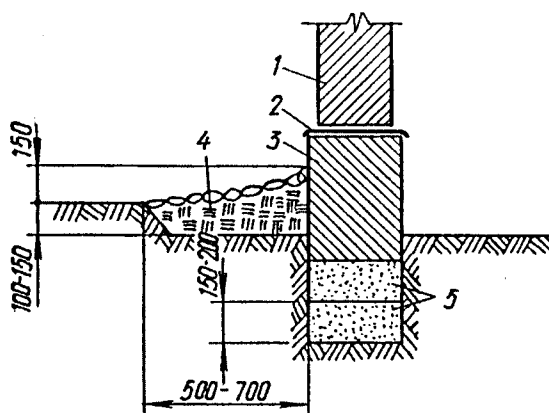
Схема кам'яного (цегляного) фундаменту з подушкою: 1 – стіна; 2 – горизонтальна гідроізоляція; 3 – кладка фундаменту; 4 – вимощення; 5 – подушка.
